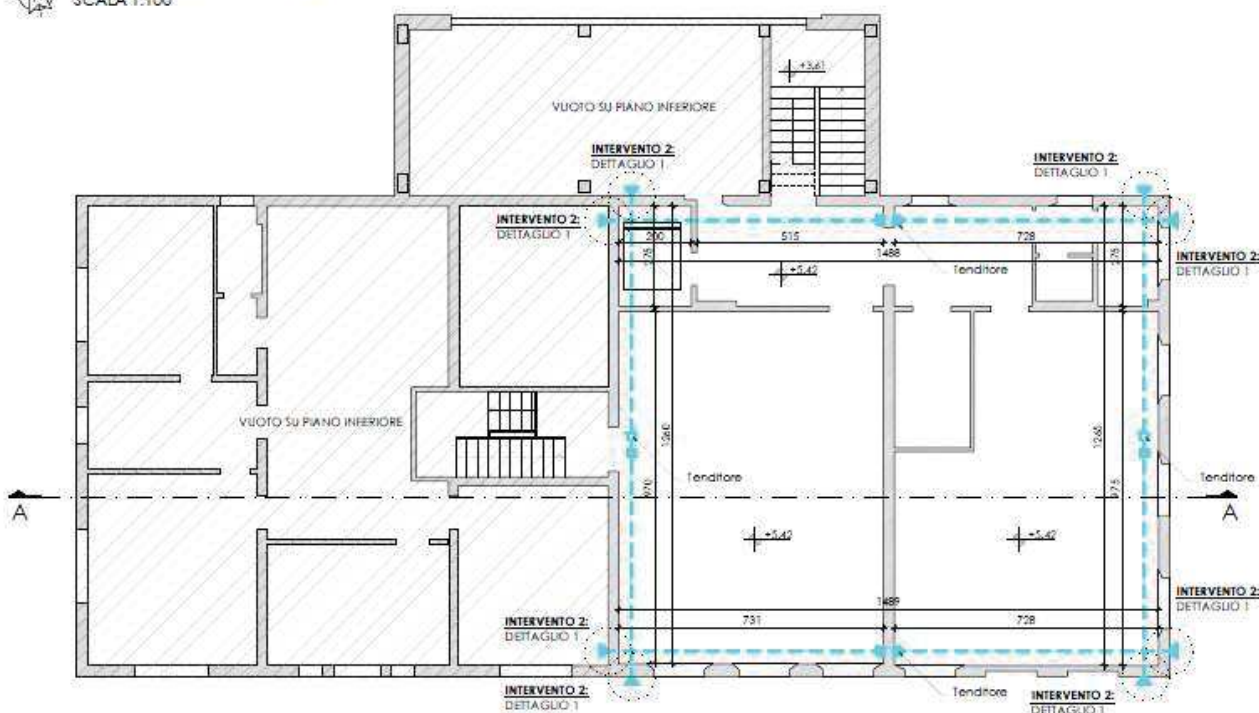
Pianta a quota +5.42m – Individuazione interventi
